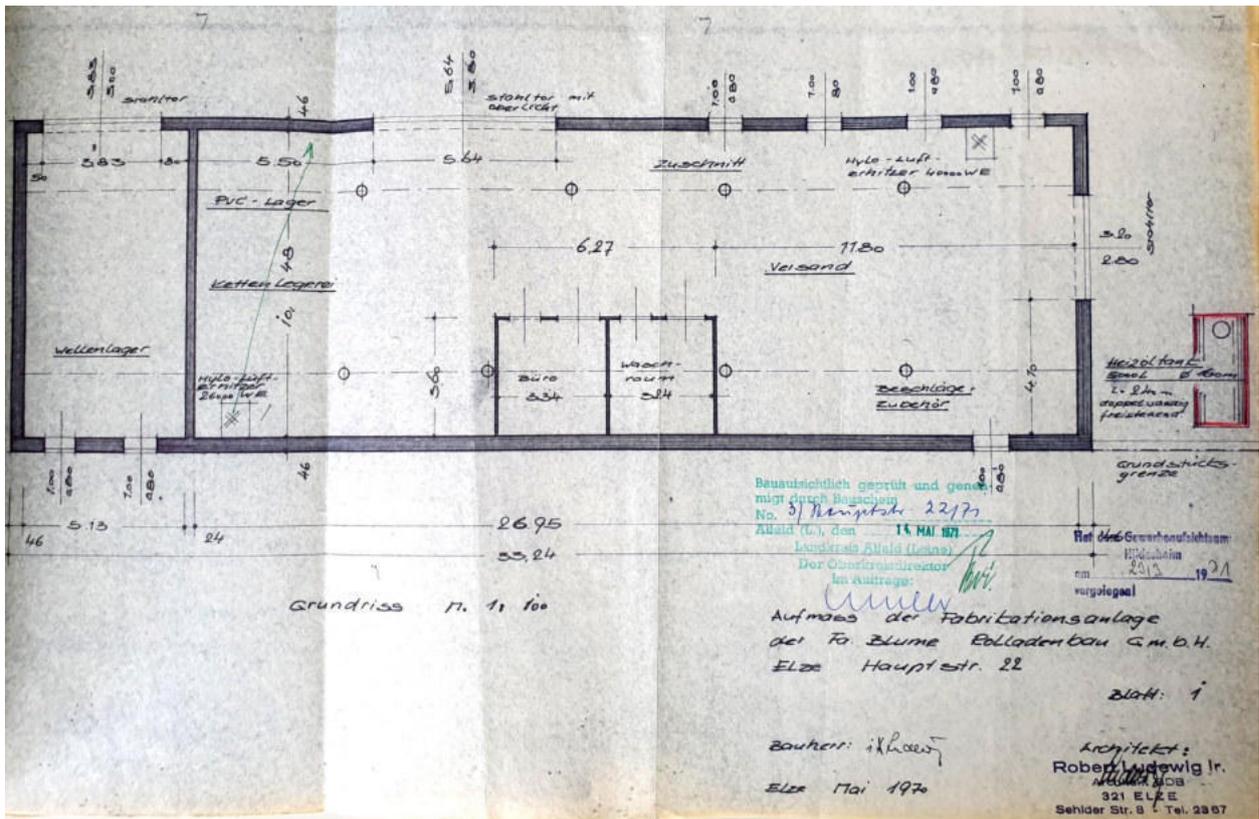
Erdgeschoss-Grundriss der ehemaligen Stallung mit Nutzung als Fabrikationsgebäude für Rolläden (Firma Blume), 1970.
